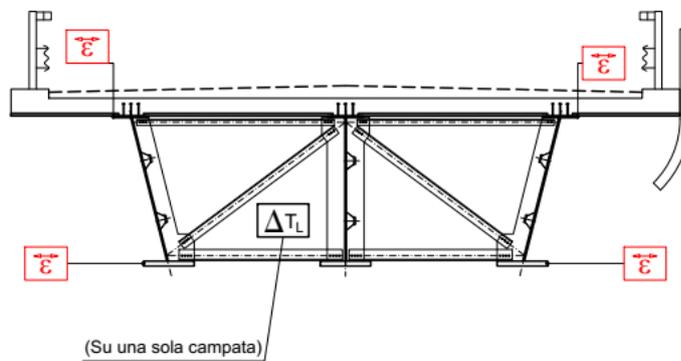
Ubicazione sensori su impalcato sezione a 3 travi (sezione trasversale viadotto Tevere)
